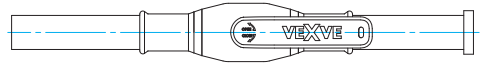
Steckverschluss. Zwischen dem Ventil und dem Steckverschluss müssen mindestens 200 mm Rohrleitung eingebaut sein.
